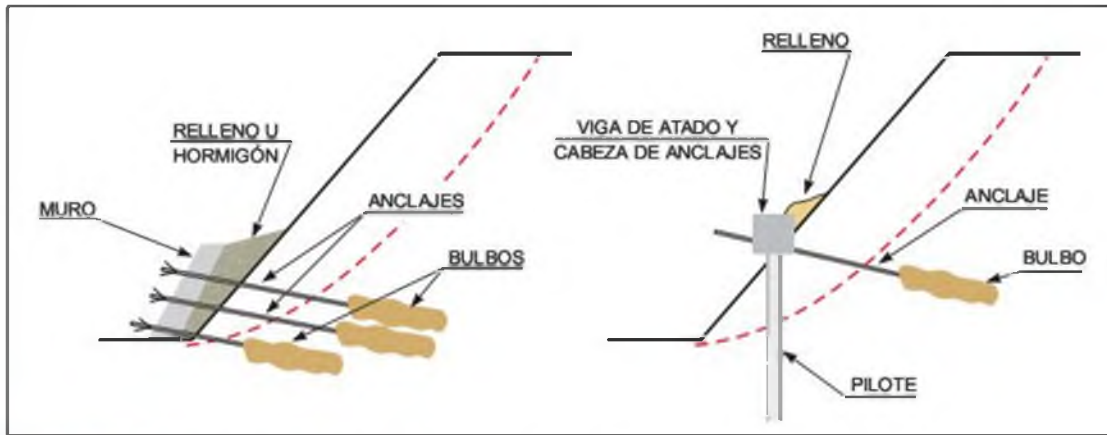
Muros y pantallas de pilotes anclados (Oteo, 1995).
